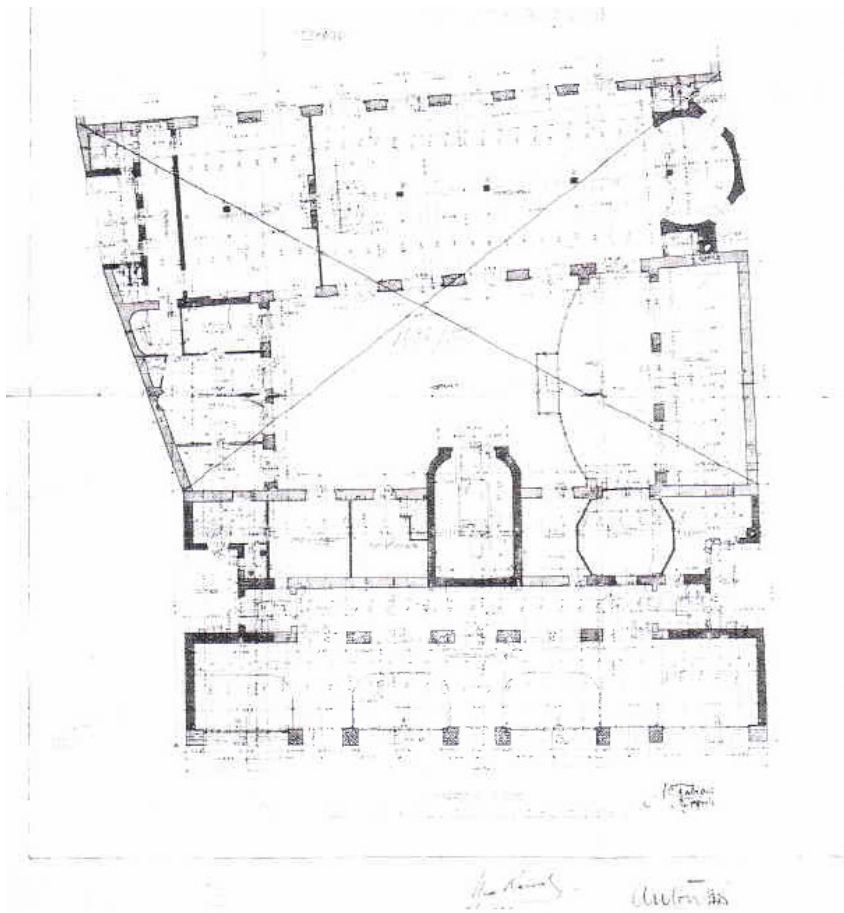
Portois & Fix Grundriss des Mezzanins, 1:100.
